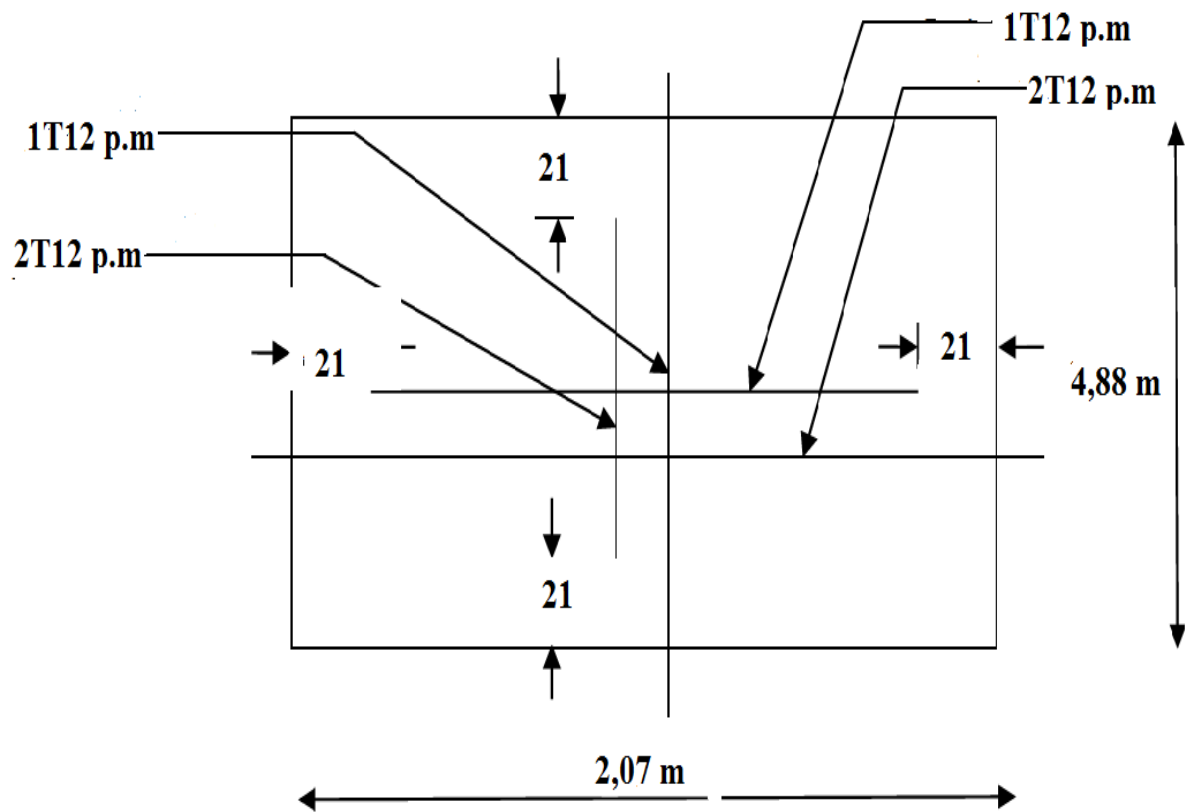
Ferrailage de la dalle balcon sur 4 cotés
